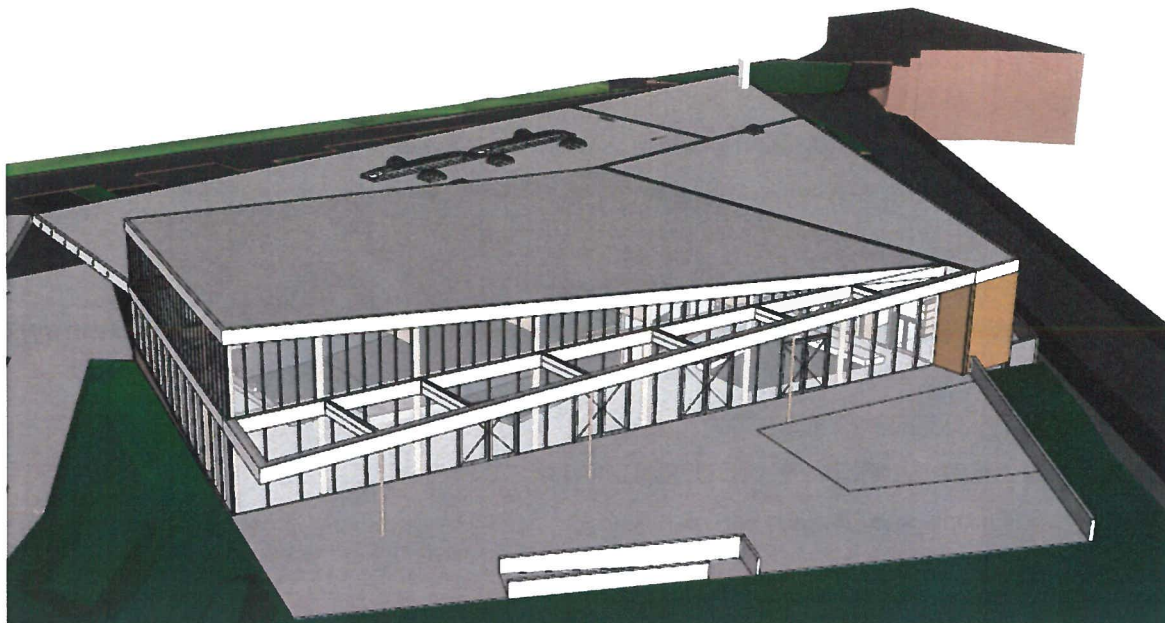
Présence d'un brise soleil façade Sud – Image : maquette sketchup de l'architecte
